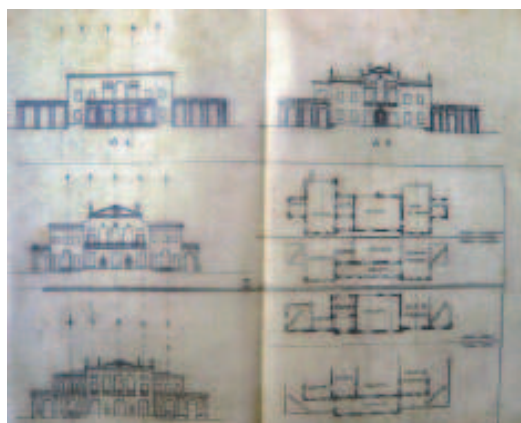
Propostas A4, A5, E, F para a fachada sobre a avenida (©ATBS).
